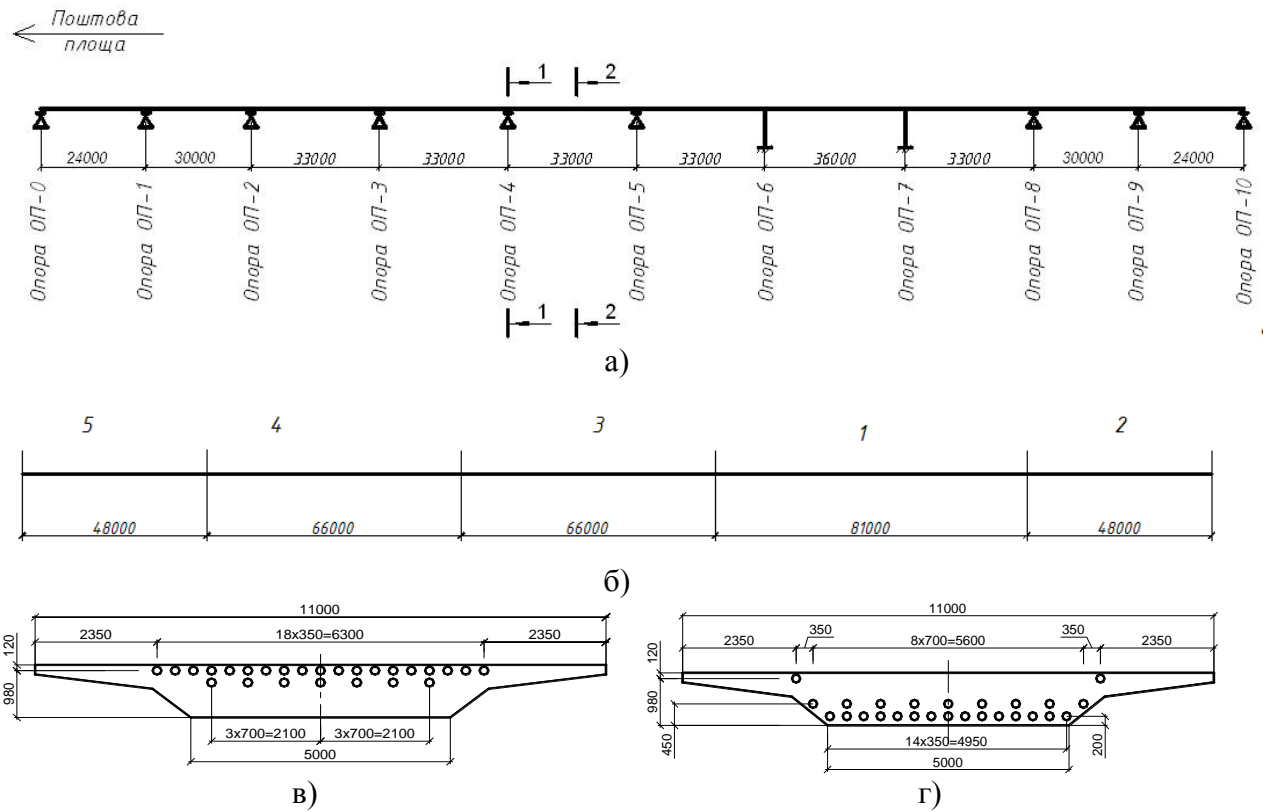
а – схема естакади; б – секції бетонування прогонової будови, в – переріз 1-1; г – переріз 2-2
